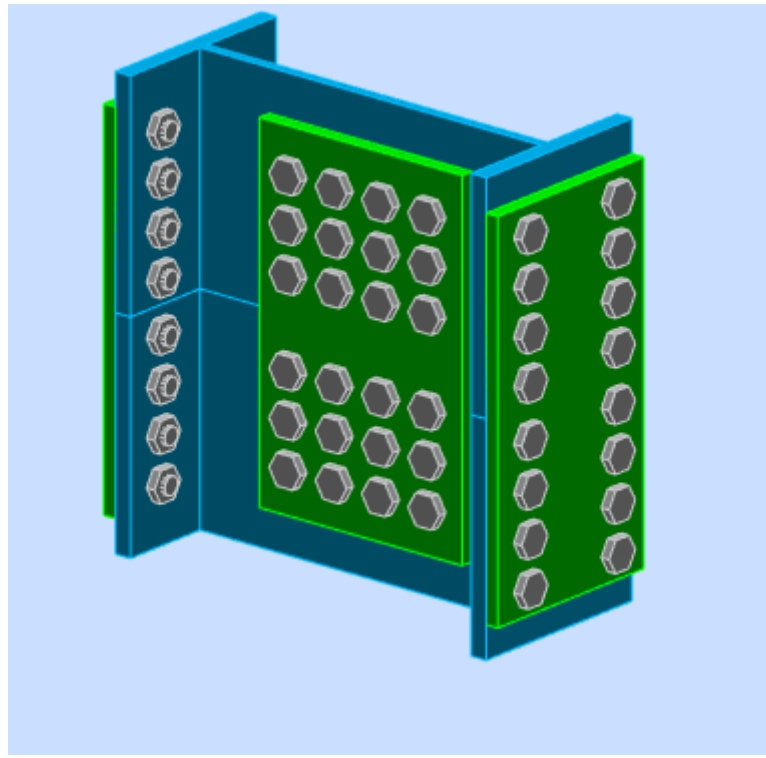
1 : Assemblage poteau-poteau HEA650/HEA650
